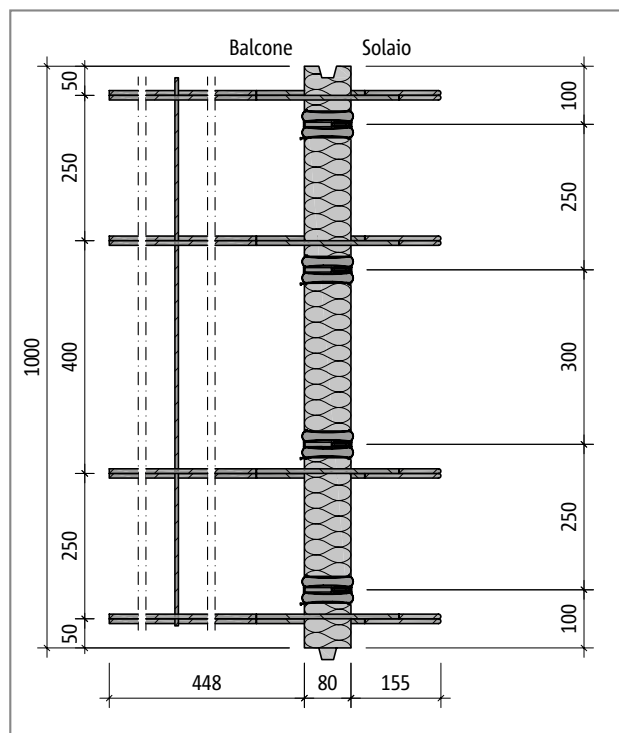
Schöck Isokorb® tipo Q10S-VV, pianta del prodotto
